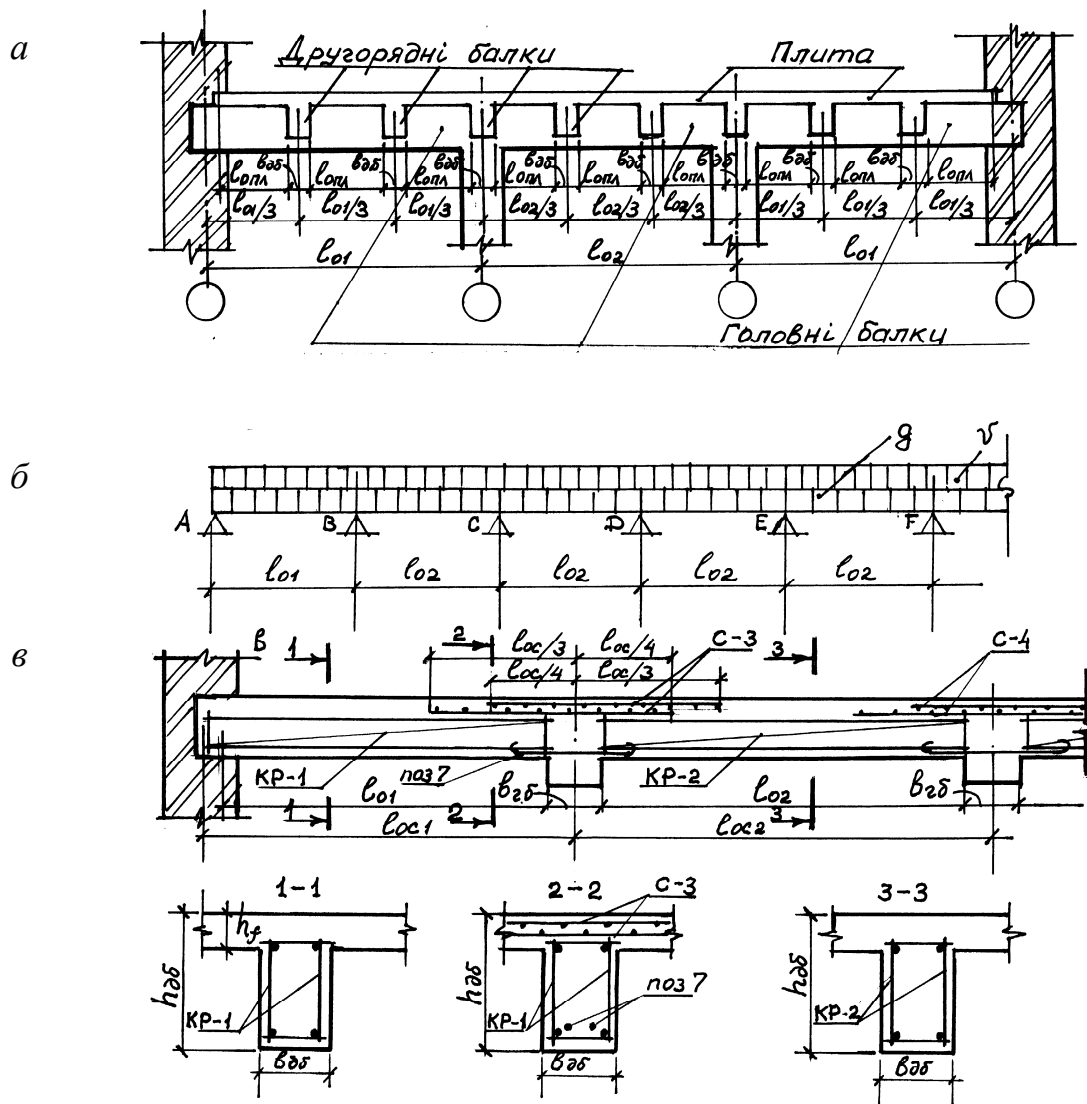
Розрахункова схема й армування другорядної балки:
